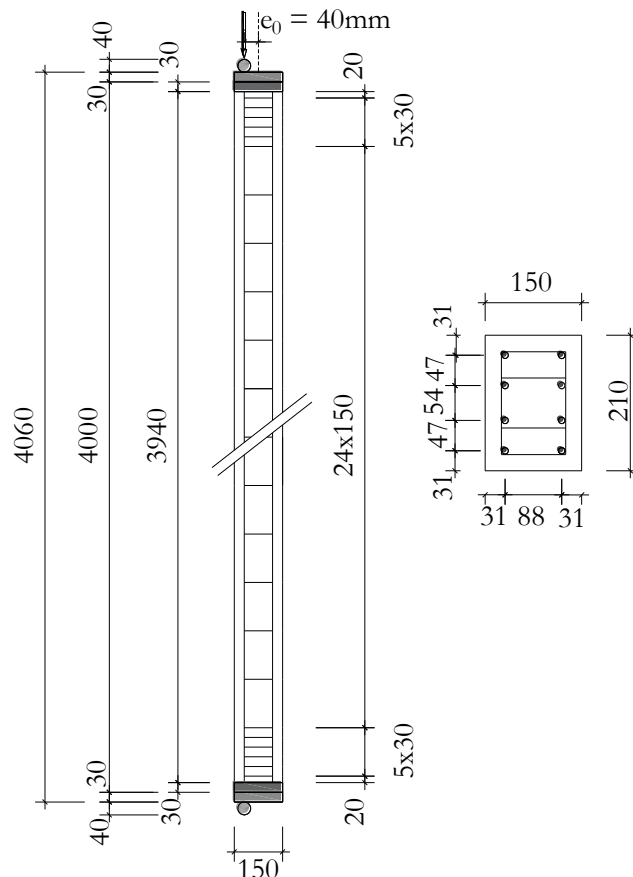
Geometria, carregamento e armaduras dos pilares, dimensões em mm (GAJDOSOVA, 2010)
